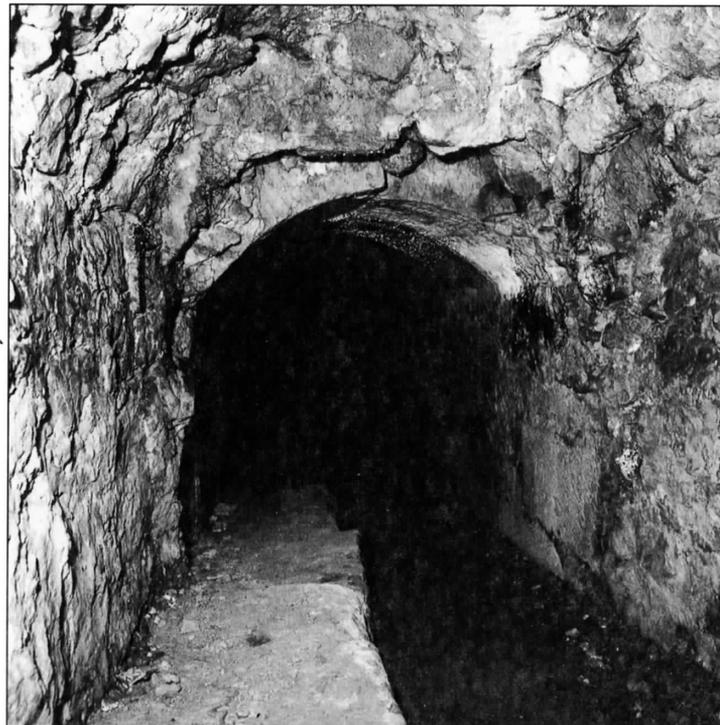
Tramo de sillería, más bajo y estrecho que los de mampostería.
